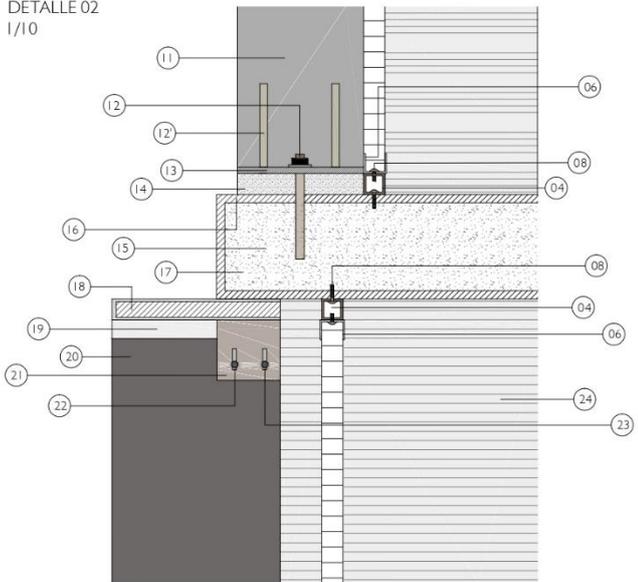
Sección constructiva escala 1/20. Fuente: propia
